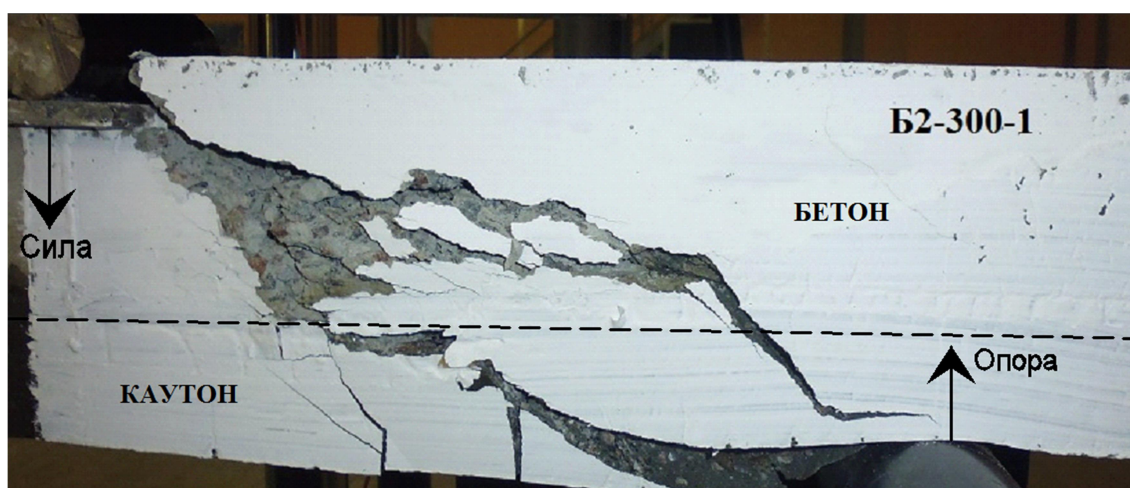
Разрушенные каутоно-бетонные балки по наклонным сечениям:
